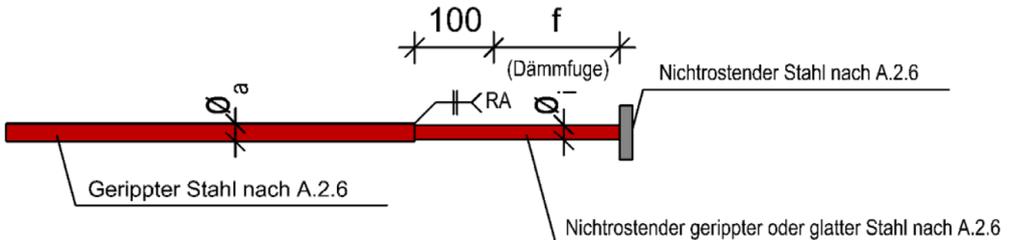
Druckstabvariante 4 – stumpfgeschweißt mit einseitiger Druckplatte
